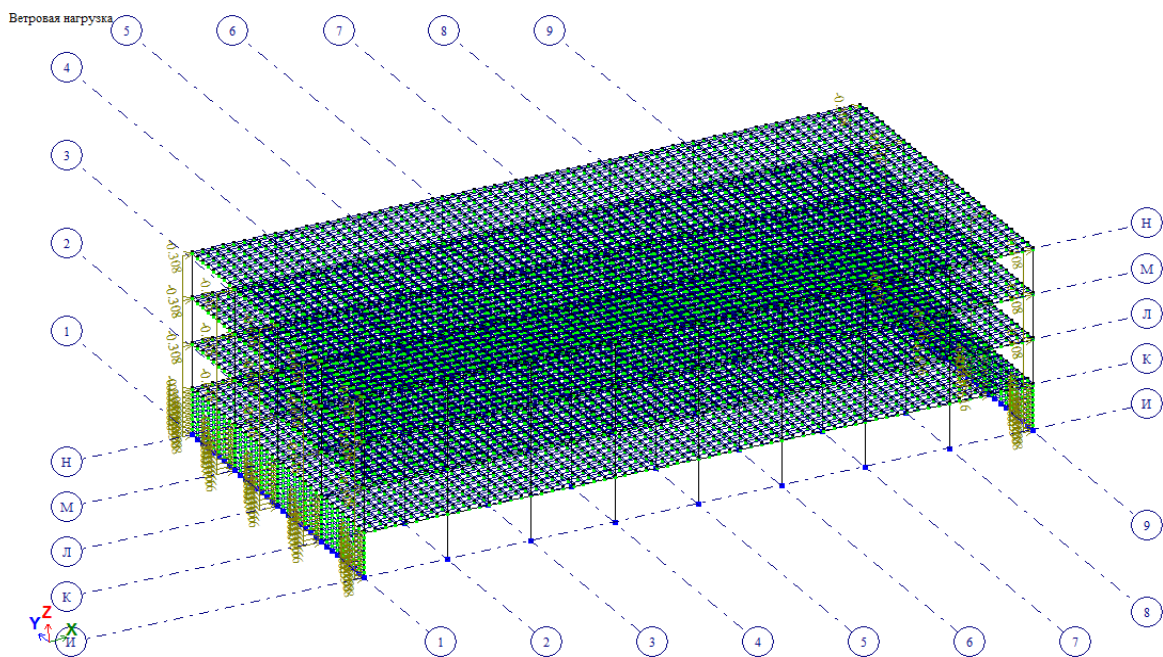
Ветровая нагрузка с грузовой площади на торцевые колонны
